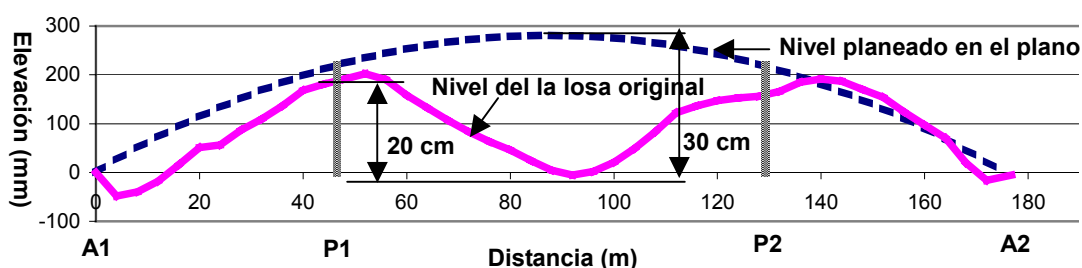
Deflexión en el Puente No.17 sobre el Río Chirripó
